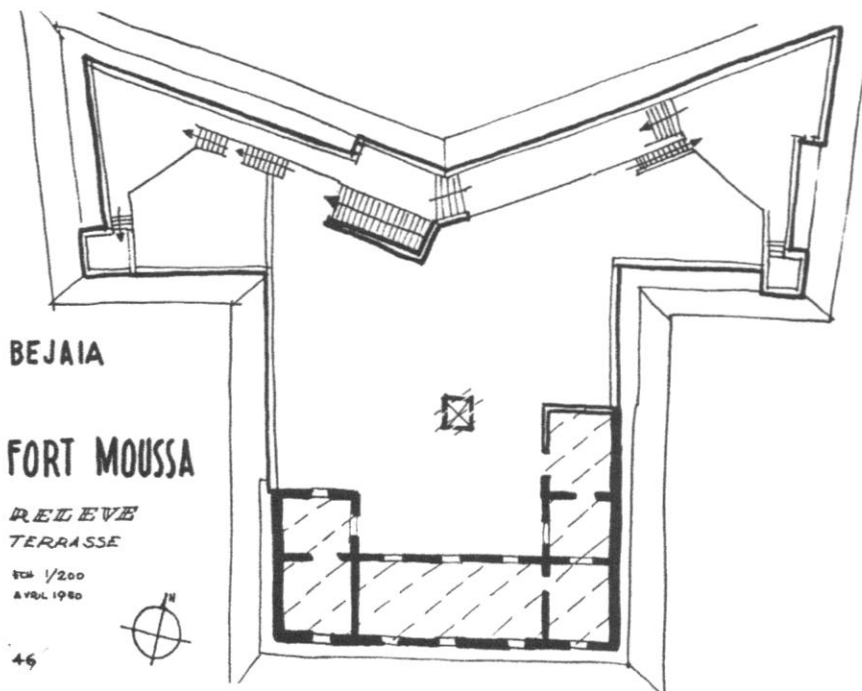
Plan de Terrasse en 1980.⁴⁰
